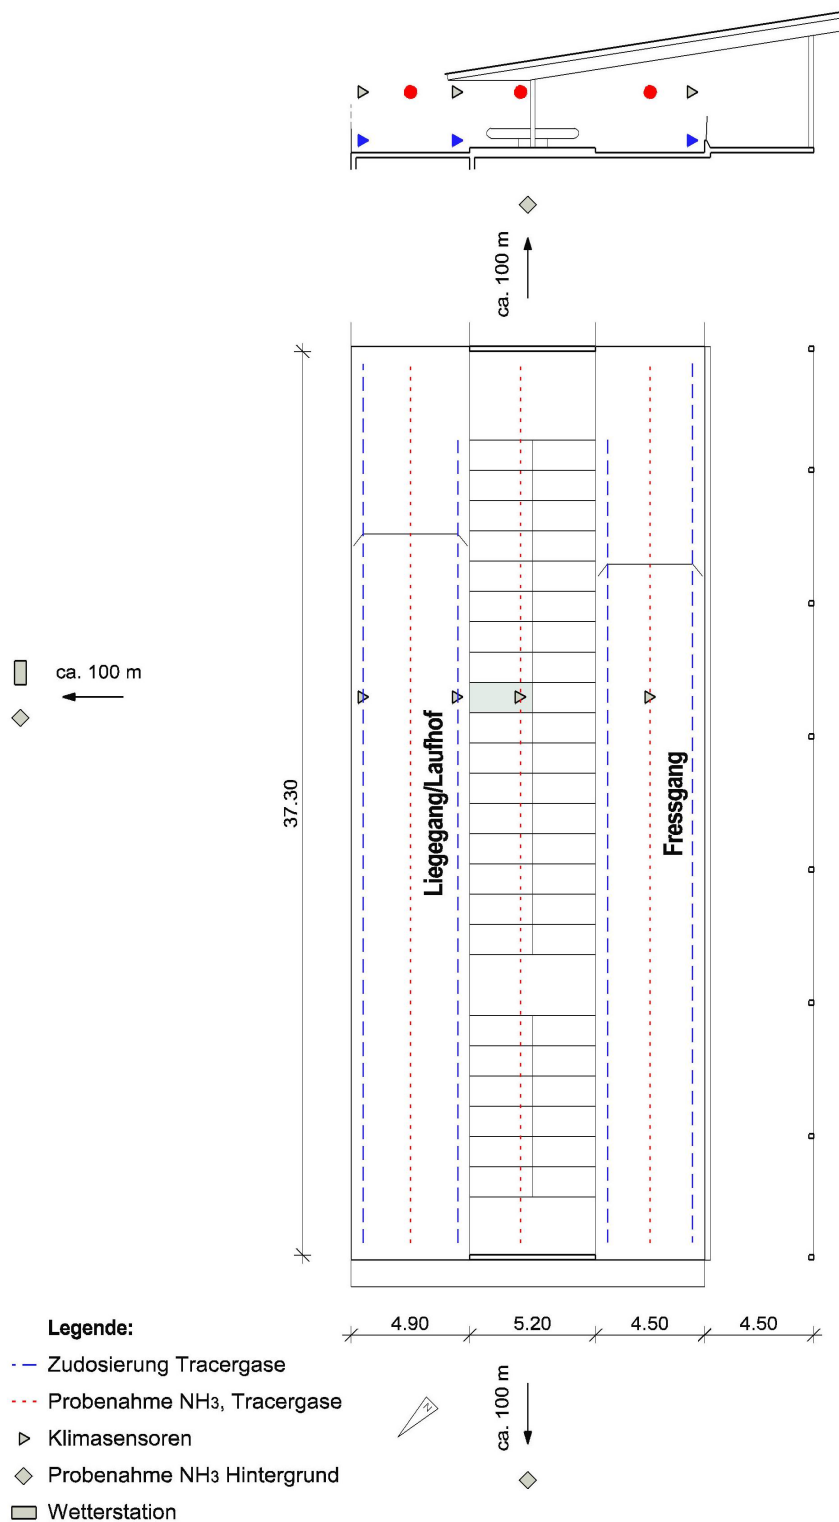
Grundriss und Schnitt des zweireihigen Liegeboxenlaufstalls mit kombiniertem Liegegang/Laufhof für Milchvieh mit Zudosierung, Probenahme sowie Klimasensoren.
